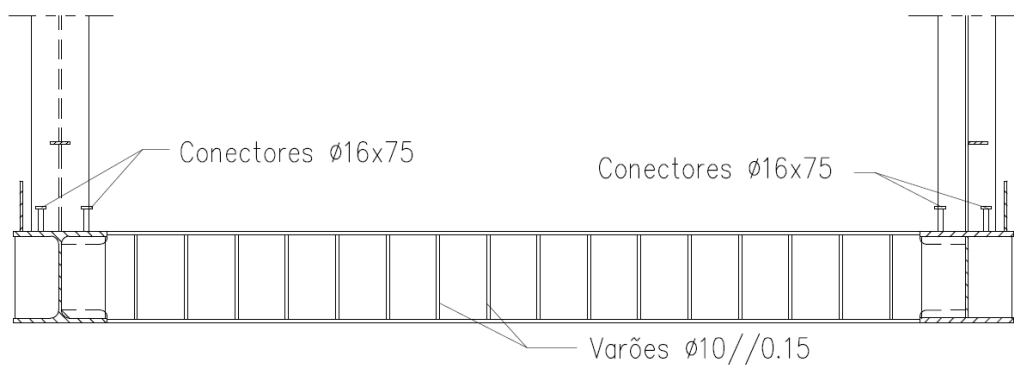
Corte transversal da estrutura metálica na zona junto aos pilares [2]
